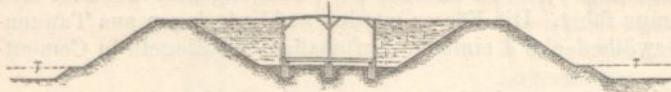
Querschnitt durch Erdwall und Pulvermagazin.
